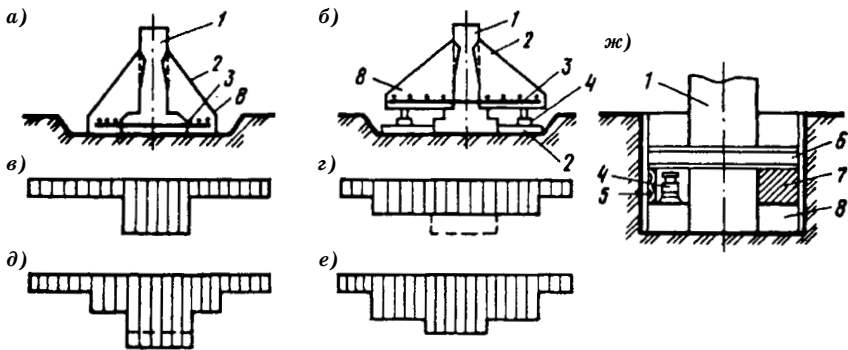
Конструкции уширения подошвы фундаментов:
